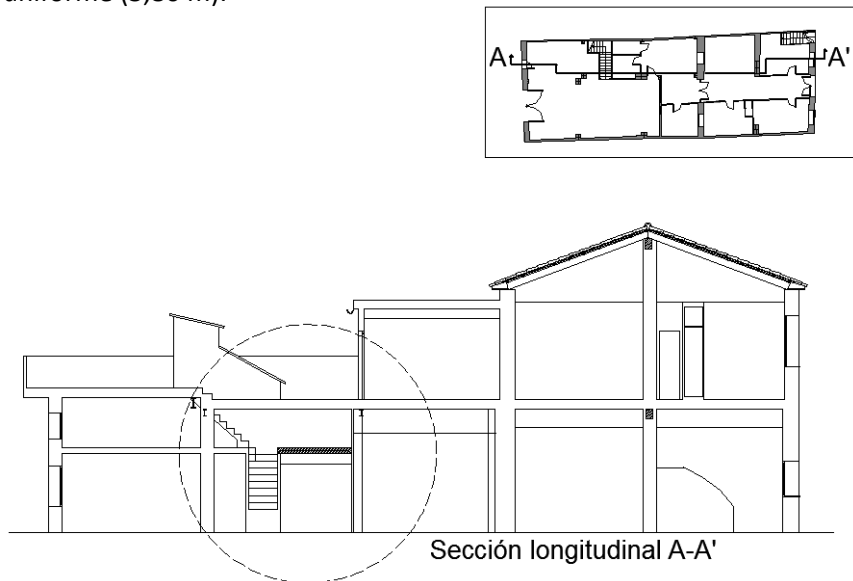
Sección longitudinal A-A' para el detalle de derribo del techo del baño y de la despensa de la vivienda de la planta baja. 2014. Elaboración propia.
